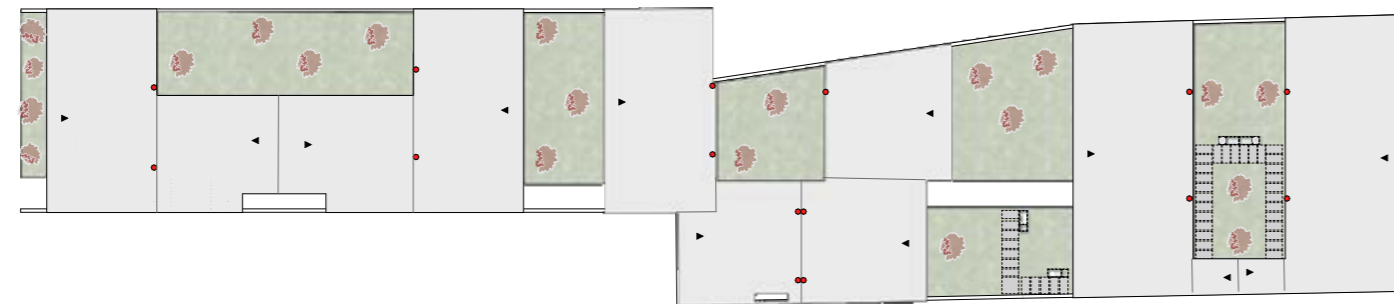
Diagrama de cubierta. Nota. Elaboración propia
